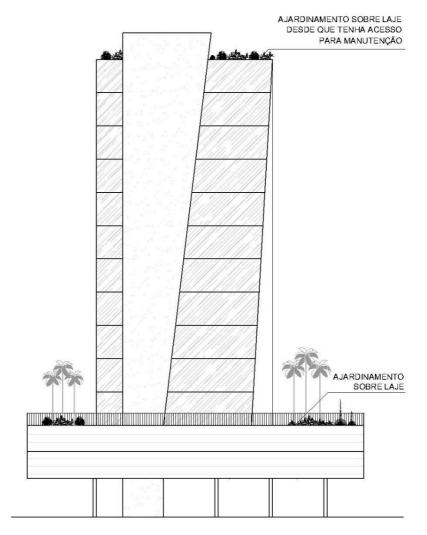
Ajardinamento sobre lajes associada à instalação de caixa de captação
